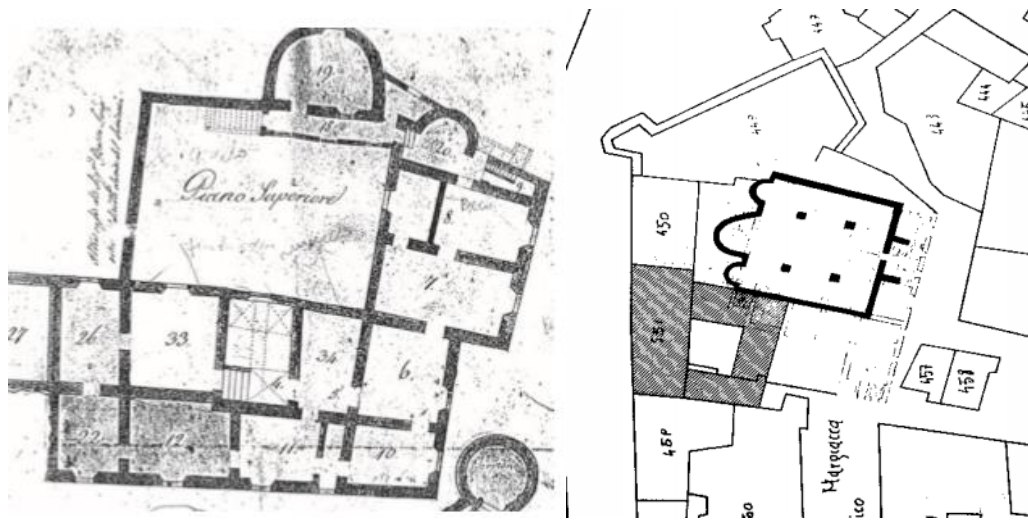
Ipotesi planimetrica⁴⁶⁷
